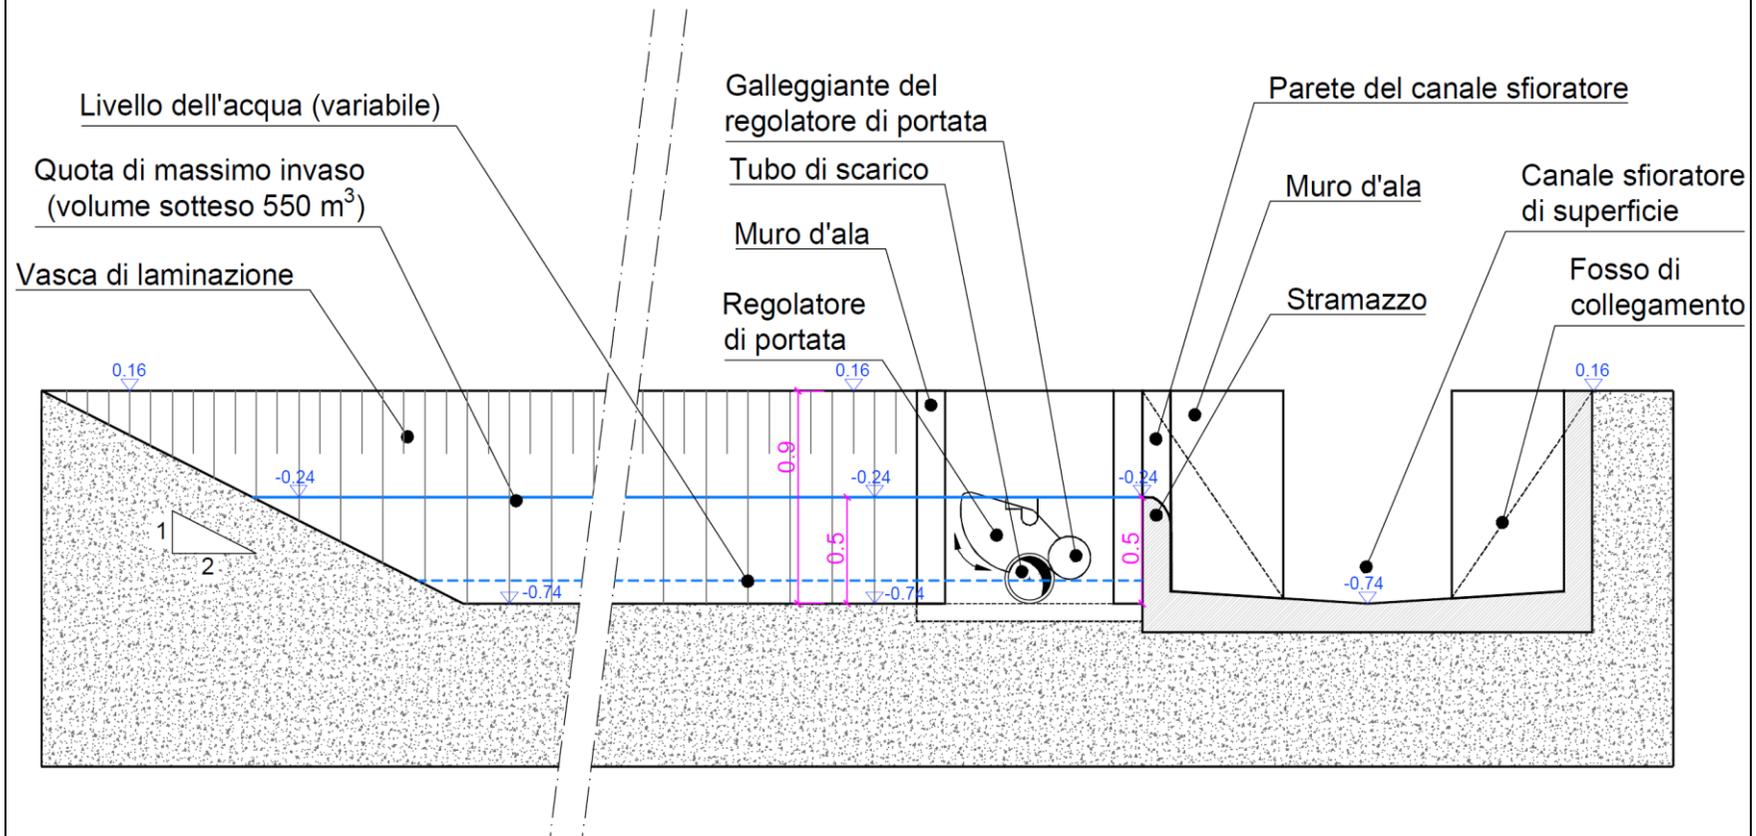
Sezione longitudinale della parte terminale del dispositivo di laminazione con vista dello scarico (sezione BB', riferimenti in Figura 18).
